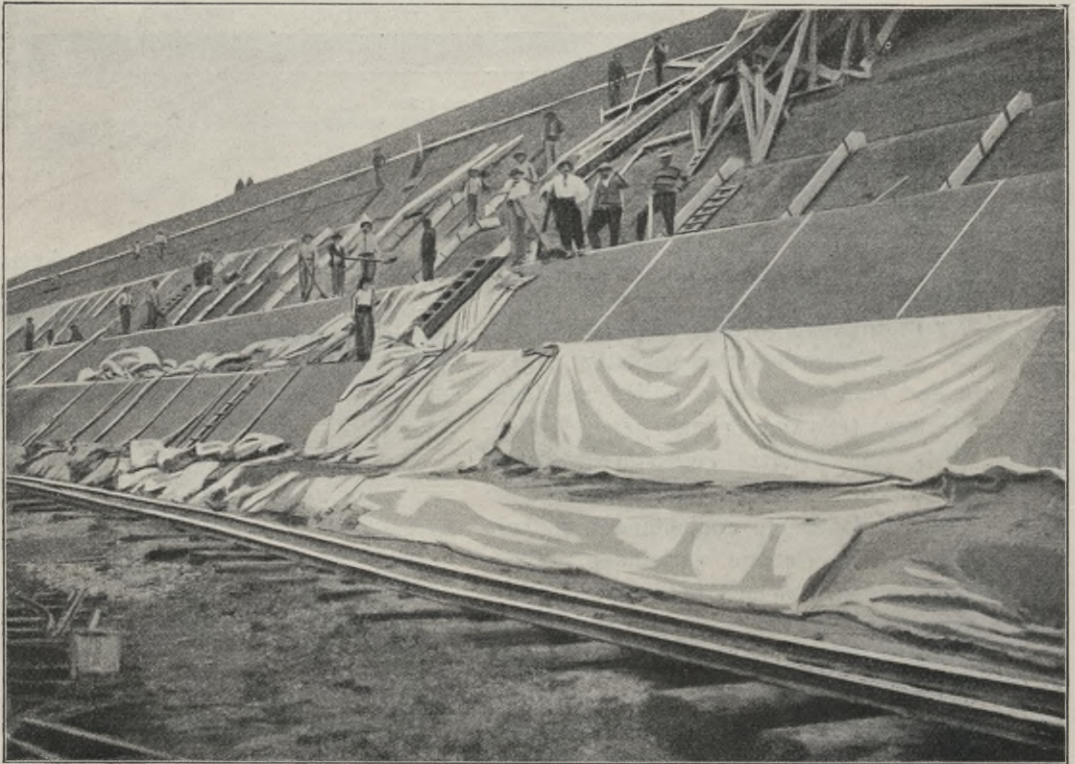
Ausführung der Böschungsbekleidung in Beton für den Staudamm von Charmes.
